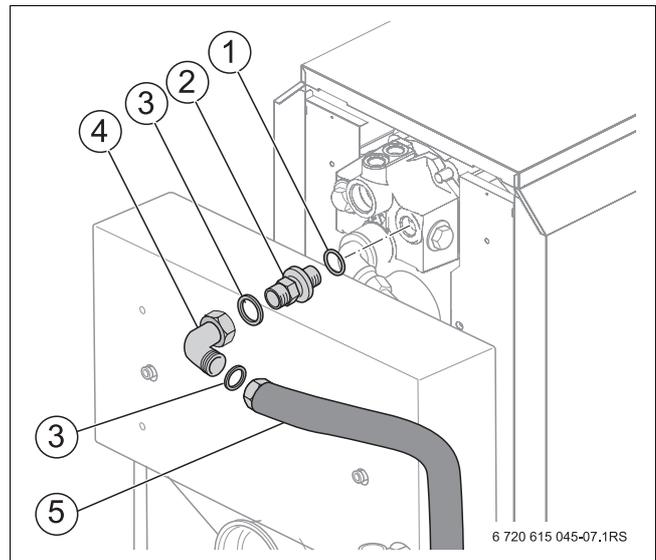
Vorlaufanschluss am Heizkessel montieren bei links nebenstehendem Warmwasserspeicher
